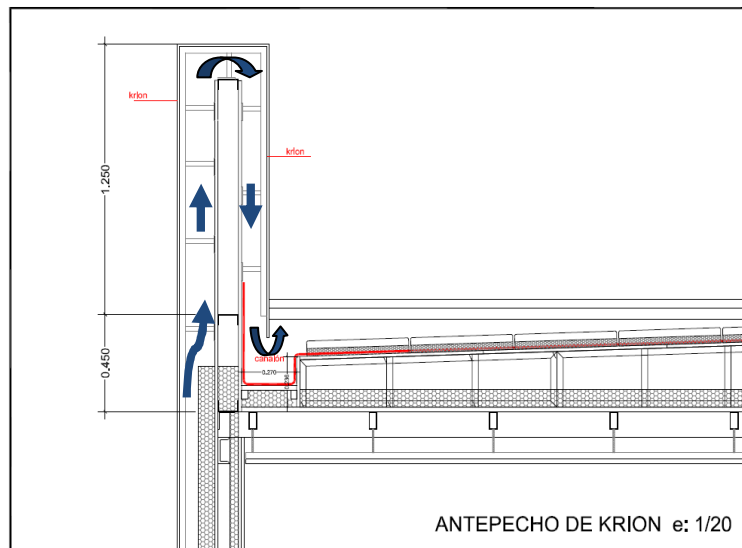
Detalle de la ventilación de la fachada ventilada del Krion / [EP]
